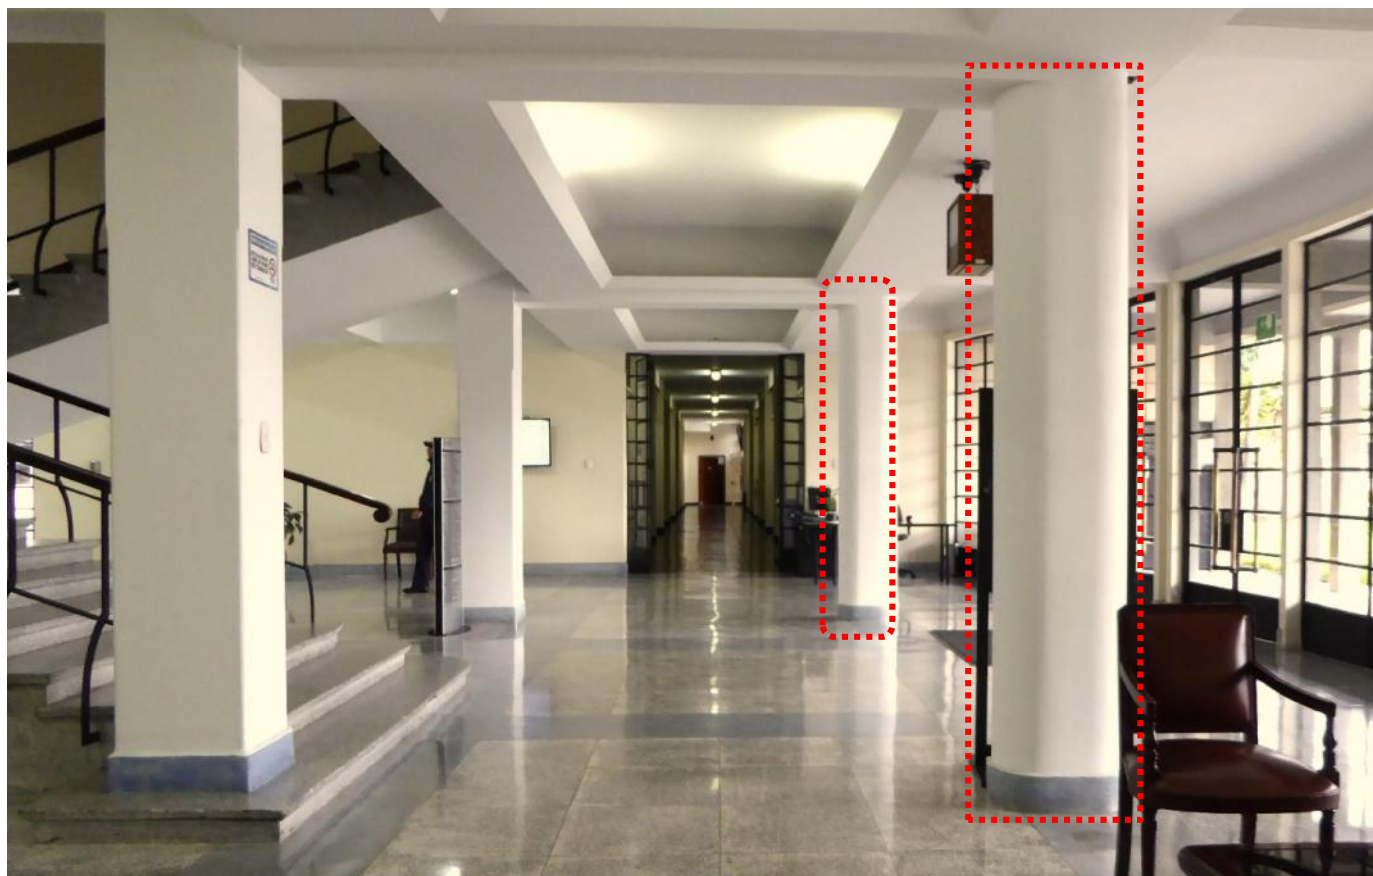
Vistas del estado actual. Fotografías CNM.
